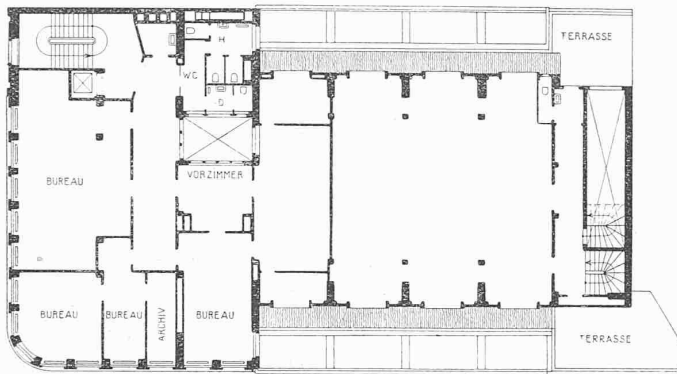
bis 12. Untergeschoss, darüber Geschäftshaus-Geschosse; rechts Obergeschoss des geplant gewesenen Autohauses. — 1 : 400.
